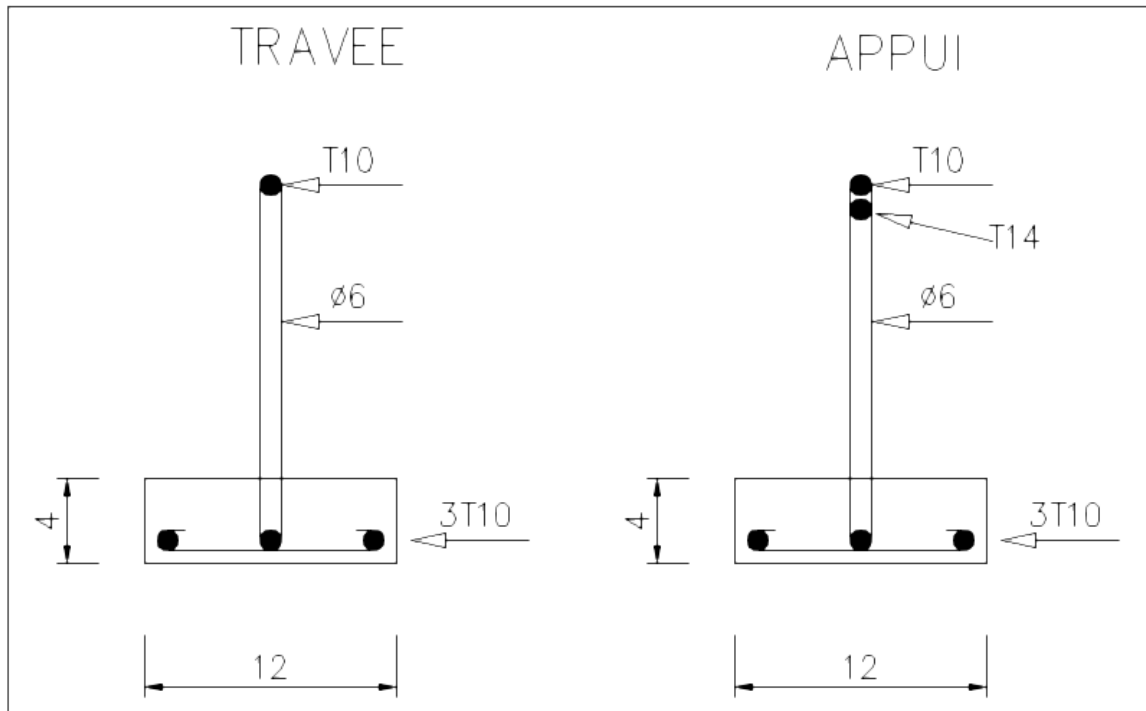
Ferrailage des poutrelles sur les différents étages.
